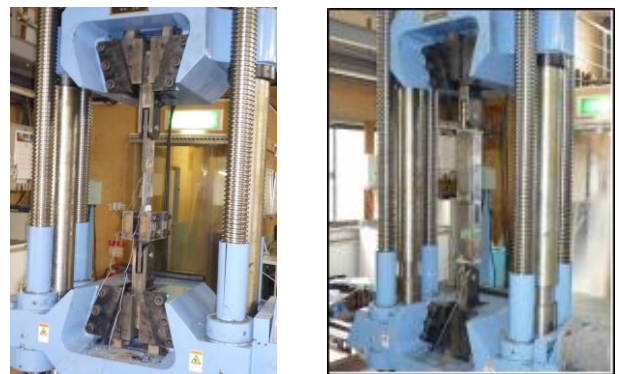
試験A加力状況 写真-2 試験Bの加力状況
